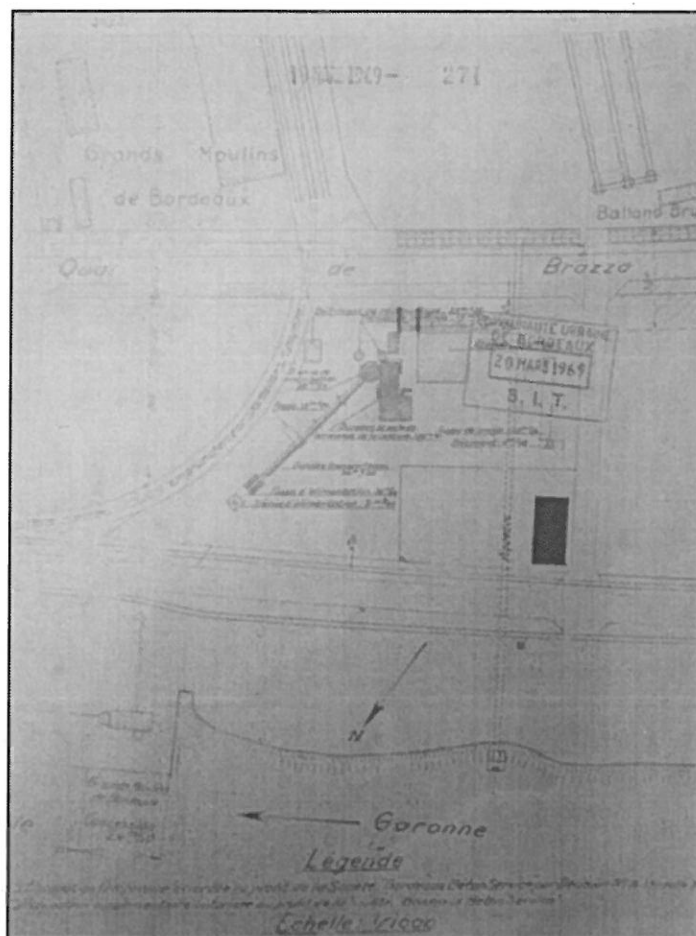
Plan de masse des installations de Bordeaux Béton Services
